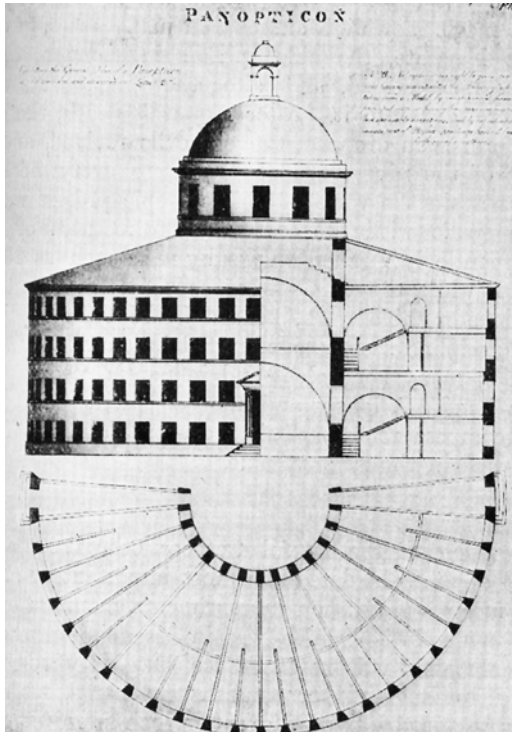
Panóptico de Bentham. Fachada, corte e planta baixa. Desenhado por Willey Reveley, 1791.
